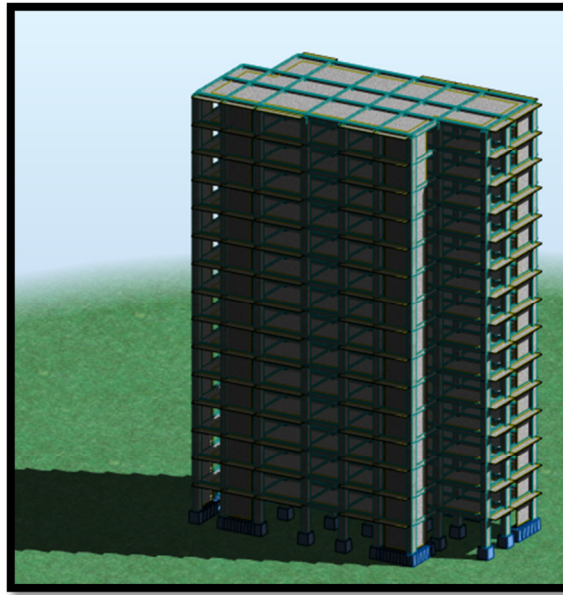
Vue en plan en 3D dans notre bâtiment
